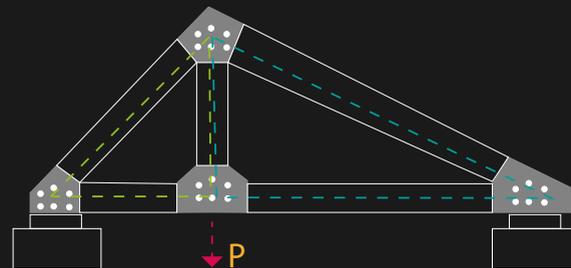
Función estructural de los puentes de armadura metálica
